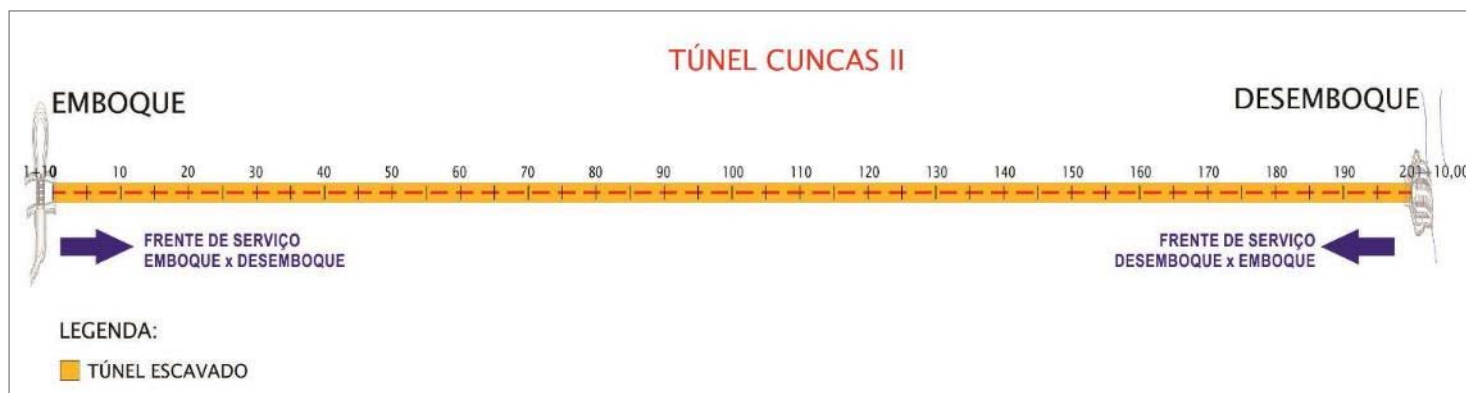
Planta esquemática com as frentes de escavação - Túnel Cuncas II
